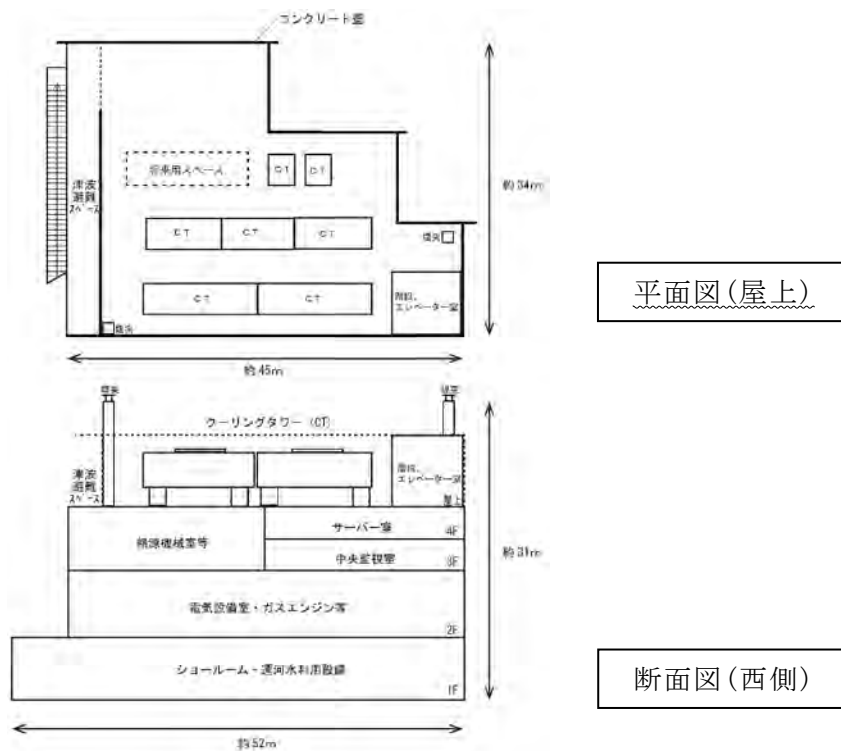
(1) エネルギー施設 A の平面図及び断面図
